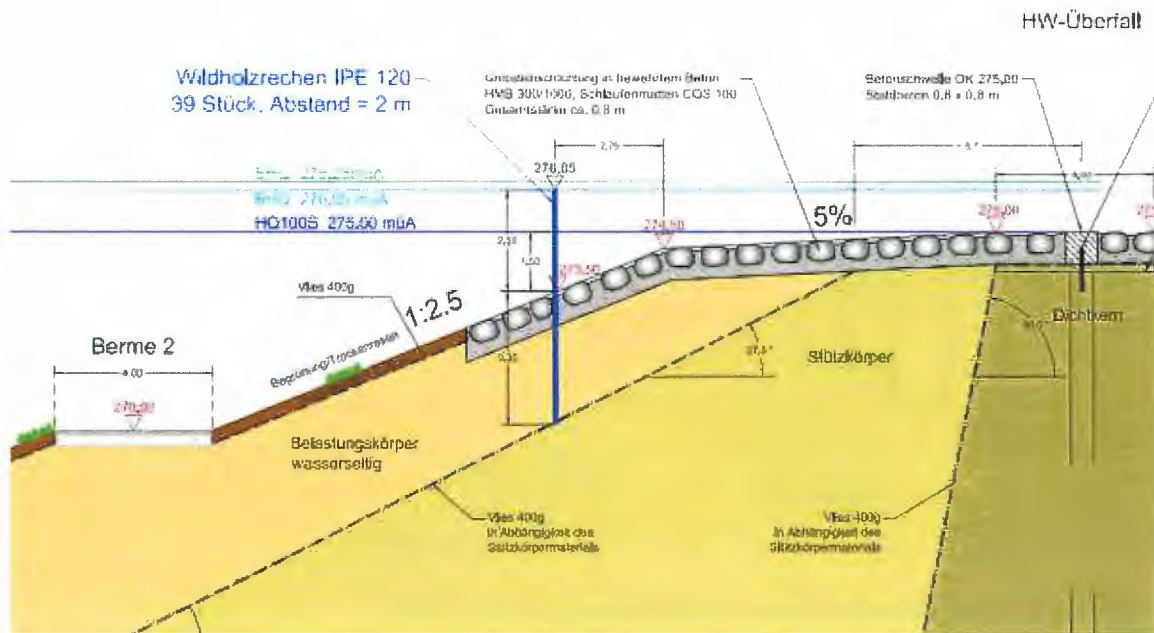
Detail Hochwasserentlastung mit Wildholzrechen; aus Plan 12.5.8
